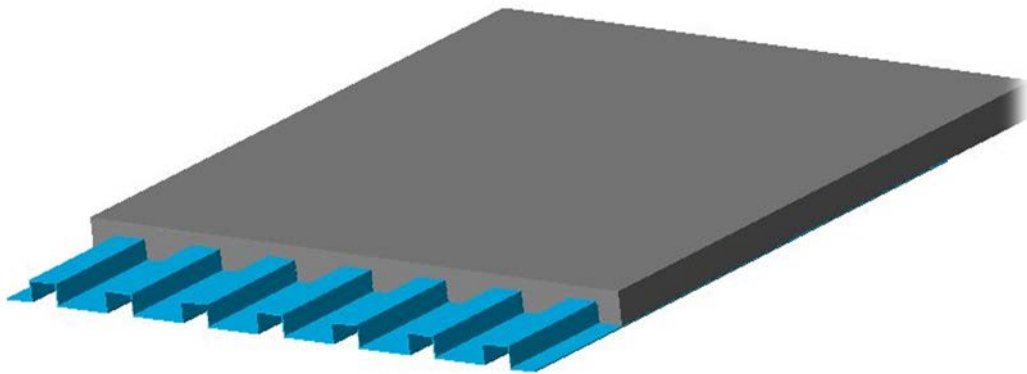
2 – Vedere în spațiu dală cutată cu secțiune mixtă oțel-beton
